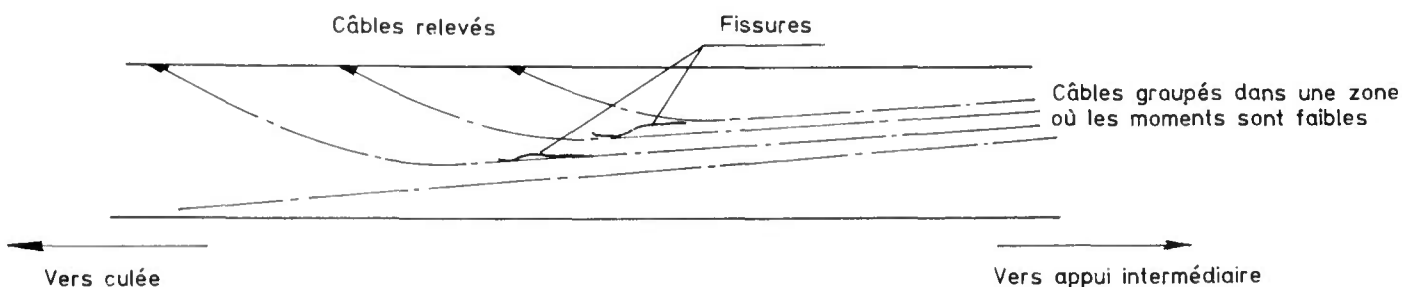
Fissures de poussée au vide dues à des déviations de câbles.
